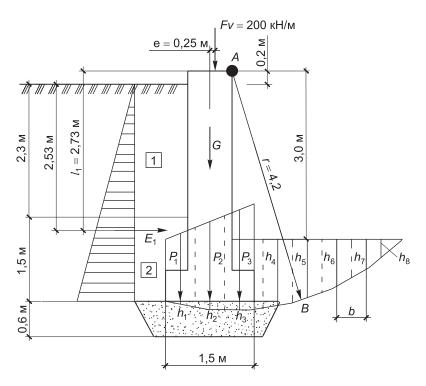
Расчетная схема стены подвала к примеру Г.13
